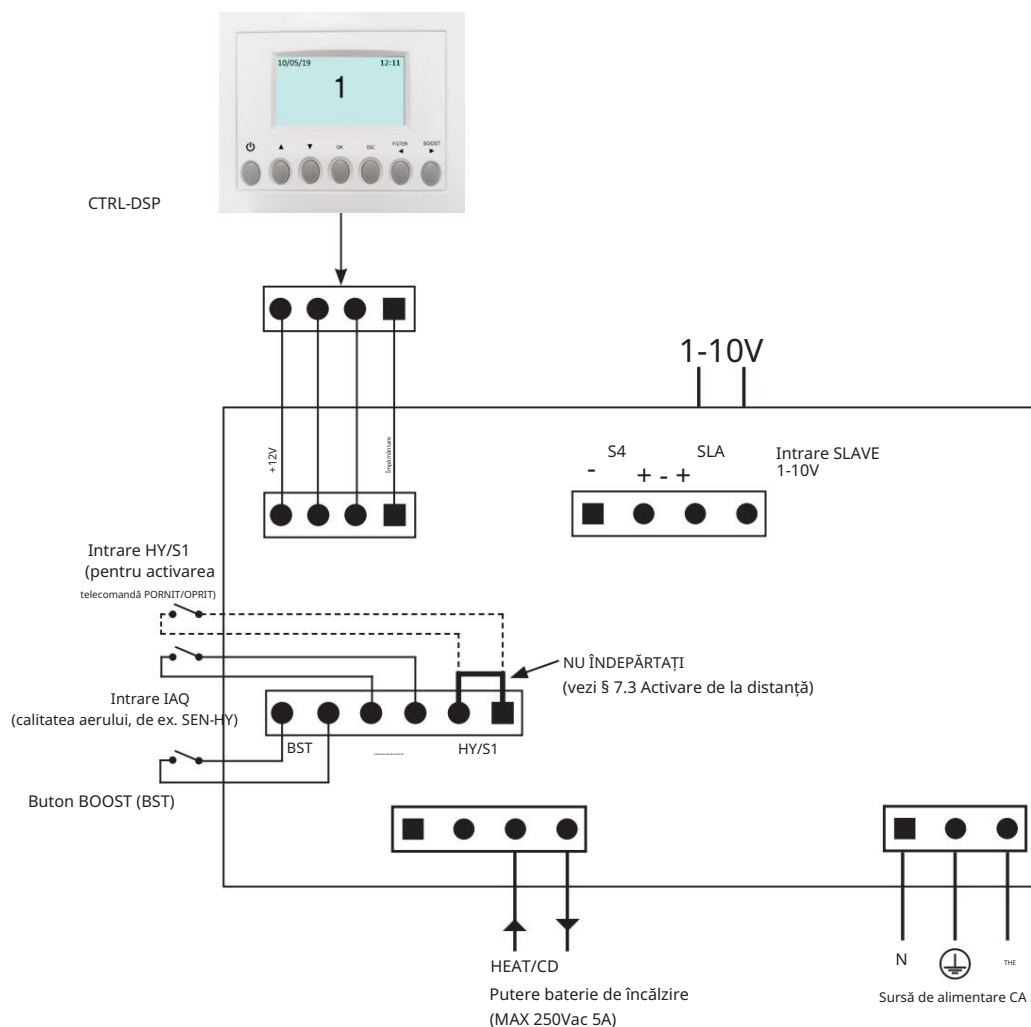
q Conexiuni electrice pe placa de bază fixată în interiorul cutiei de contacte
